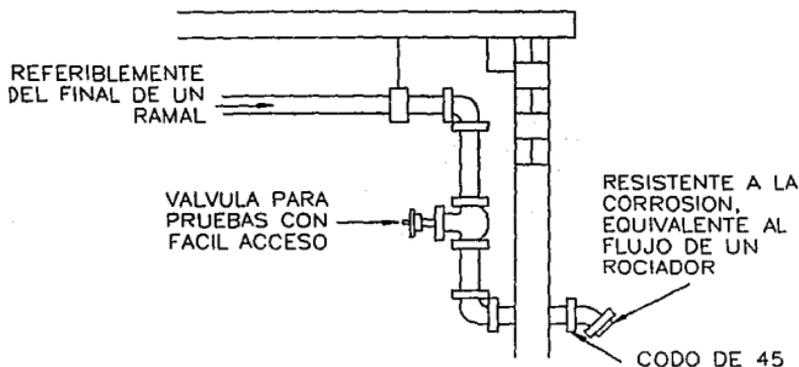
Conexión de válvula para pruebas de un sistema de tubo húmedo.(NFPA 13, A-4-7.4.2(e))
